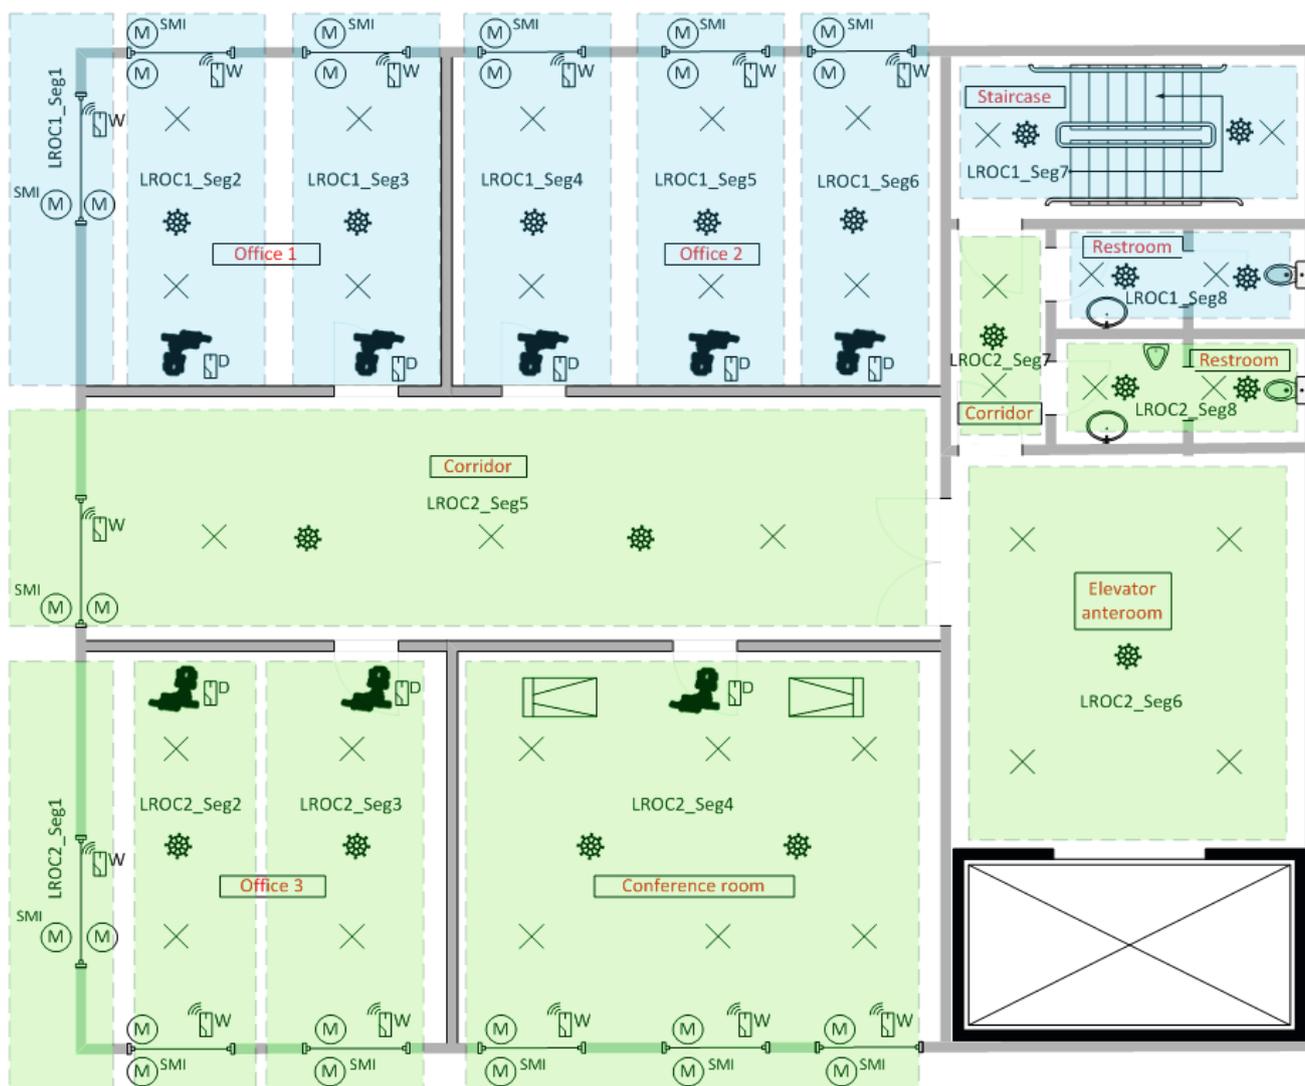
Grundrissplan mit L-ROC-Auslegung
